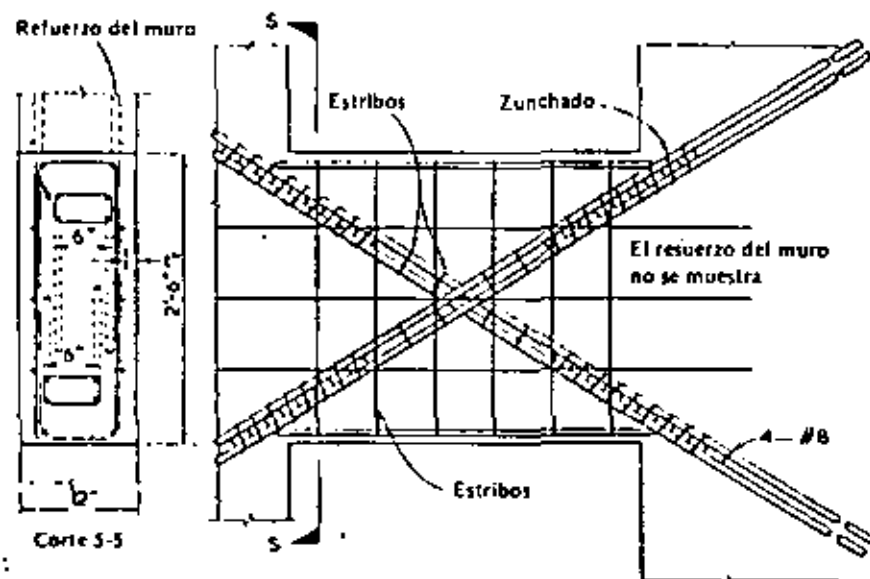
Refuerzo sugerido para una viga corta de acoplamiento (según Paulay^{3.34}).
